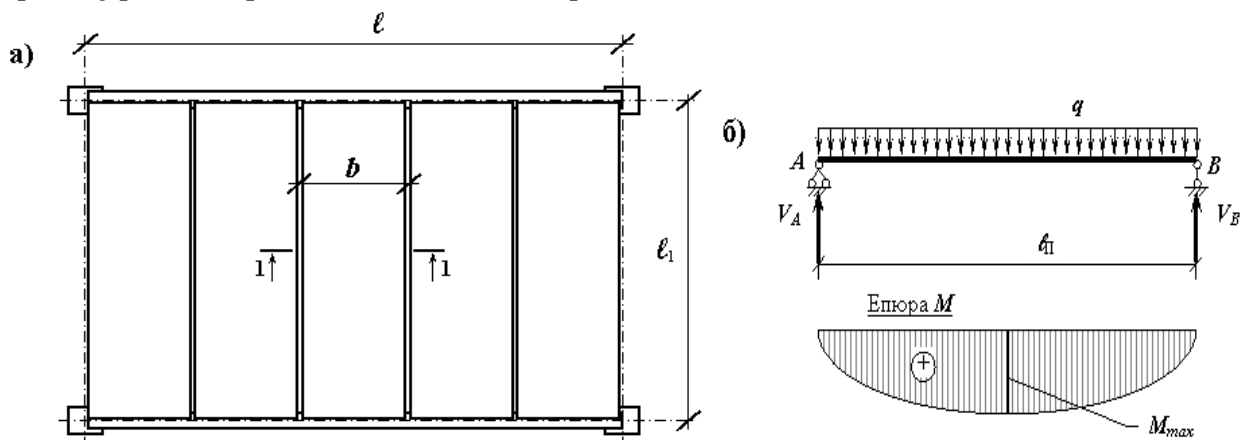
Конструктивна (а) та розрахункова (б) схеми збірної багатопустотної залізобетонної плити перекриття каркасної будівлі
